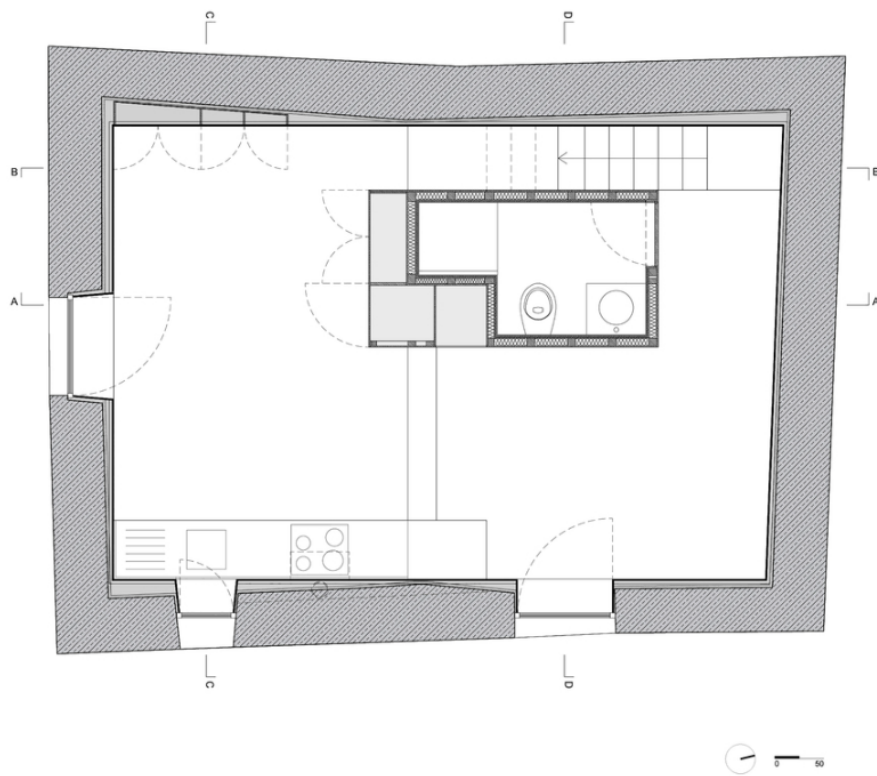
Planta do Piso 0 - Casa das Nogueiras
